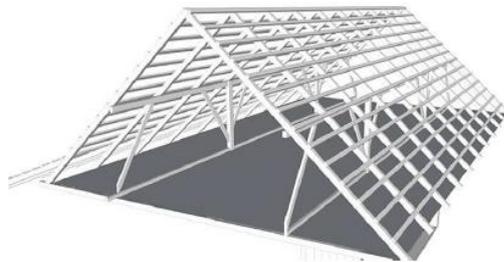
ESTRUTURA DO TELHADO DA CASA
